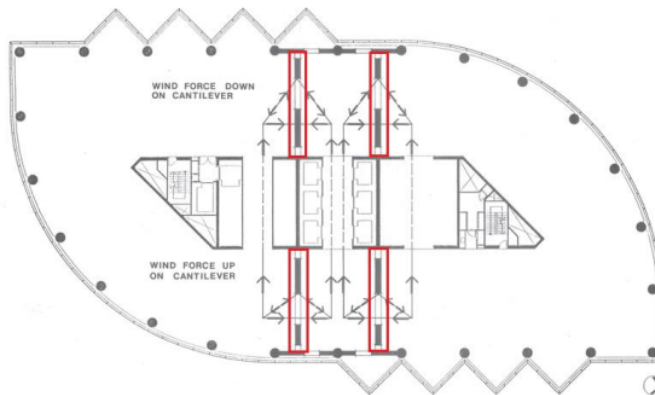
Planta de outriggers del edificio Waterfront Place – outriggers señalados en rojo (Choi et al., 2012, p.51)
